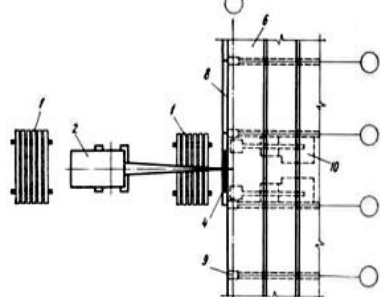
Схема монтажа стеновых ограждающих панелей, кассета расположена между краном и стеной: 1 – монтажный кран; 2 – кассета для складирования панелей стен; 3 – оттяжка из пенькового каната; 4 – двухветвевой строп; 5 – панель стены; 6 – смонтированное покрытие; 7 – стропильная ферма; 8 – стеновое ограждение; 9 – колонна; 10 – монтажный грузоподъемник на автомобиле.
